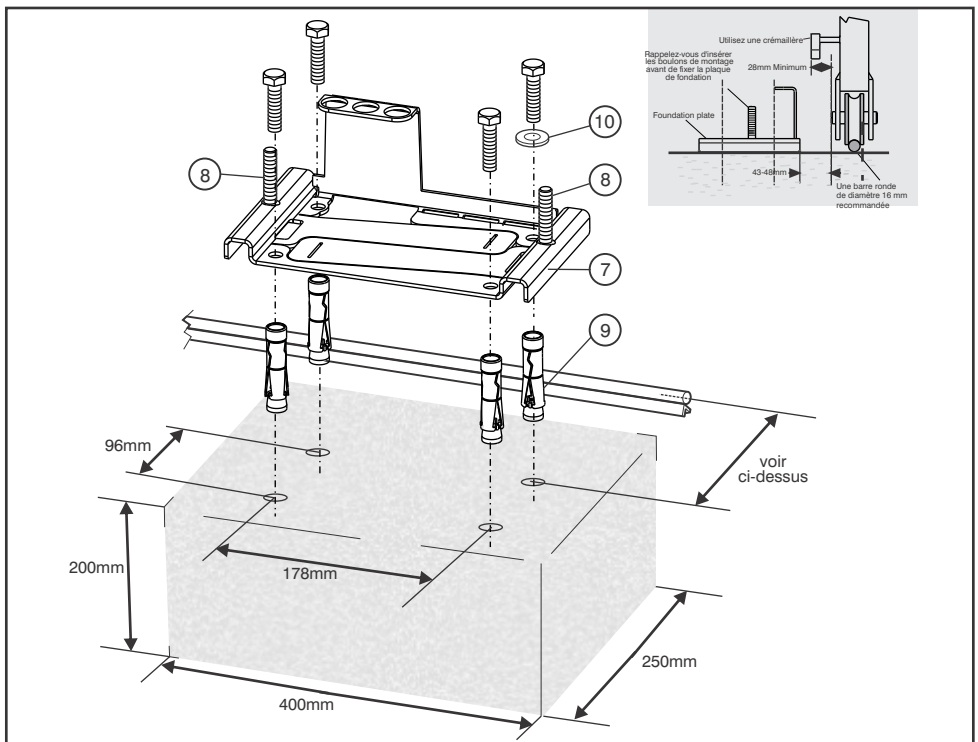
Installation de la plaque de fondation – bloc de béton préexistant
